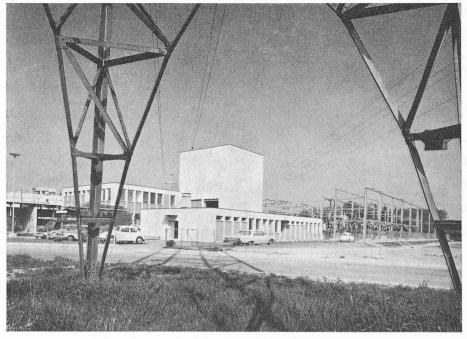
Vue d'ensemble de la sous-station de Bussigny.
